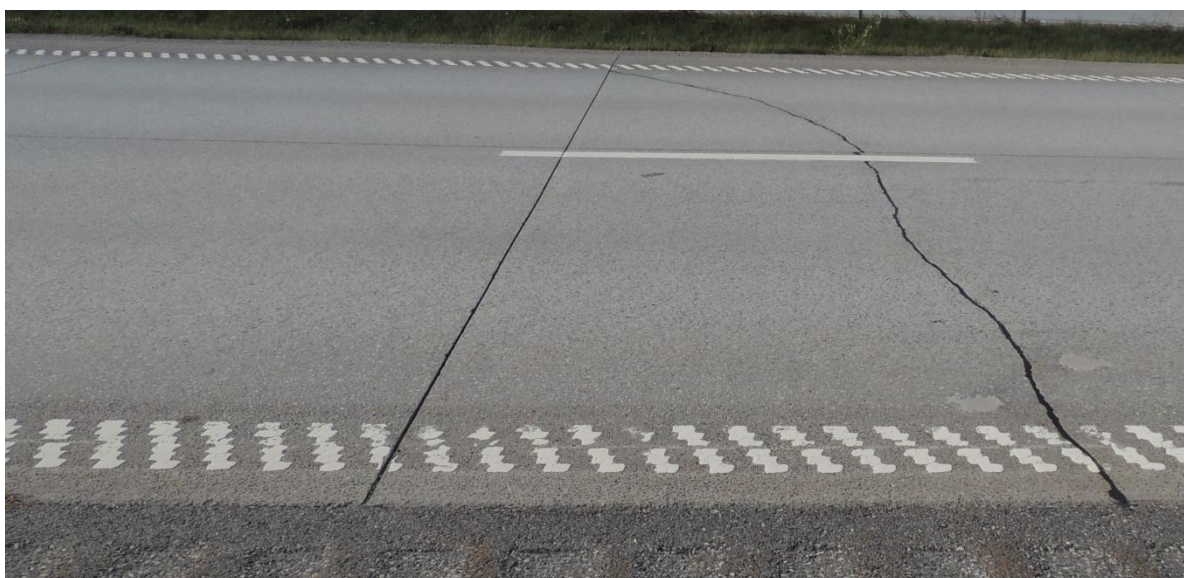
E4 Uppsala, betoonplaadi murdumine, september 2013
